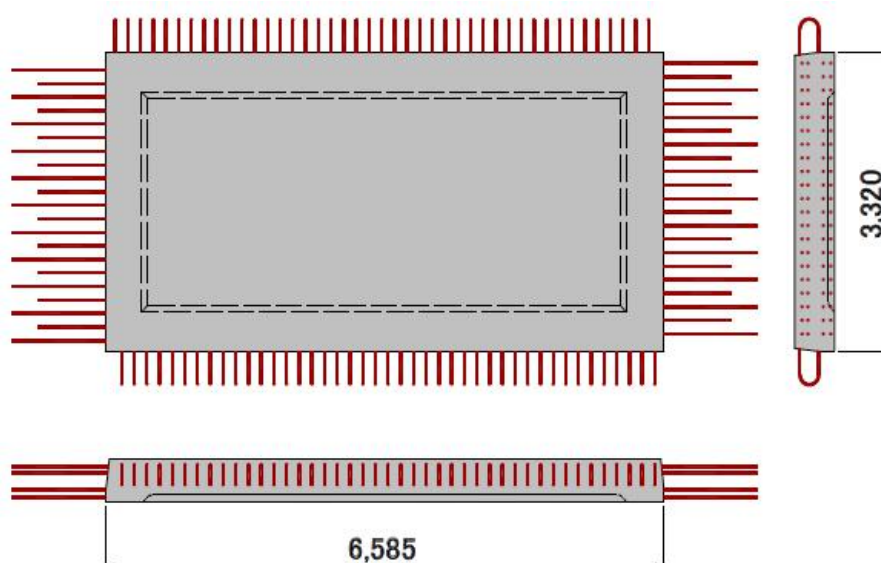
9 预制钢筋混凝土板（PC 板）（单位：mm）
